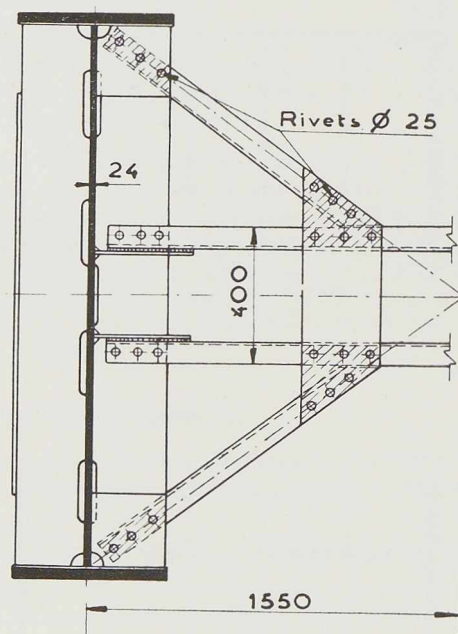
Vue suivant la flèche F du plan de la figure 22, du détail d'assemblage, du contreventement sur les poussards.
